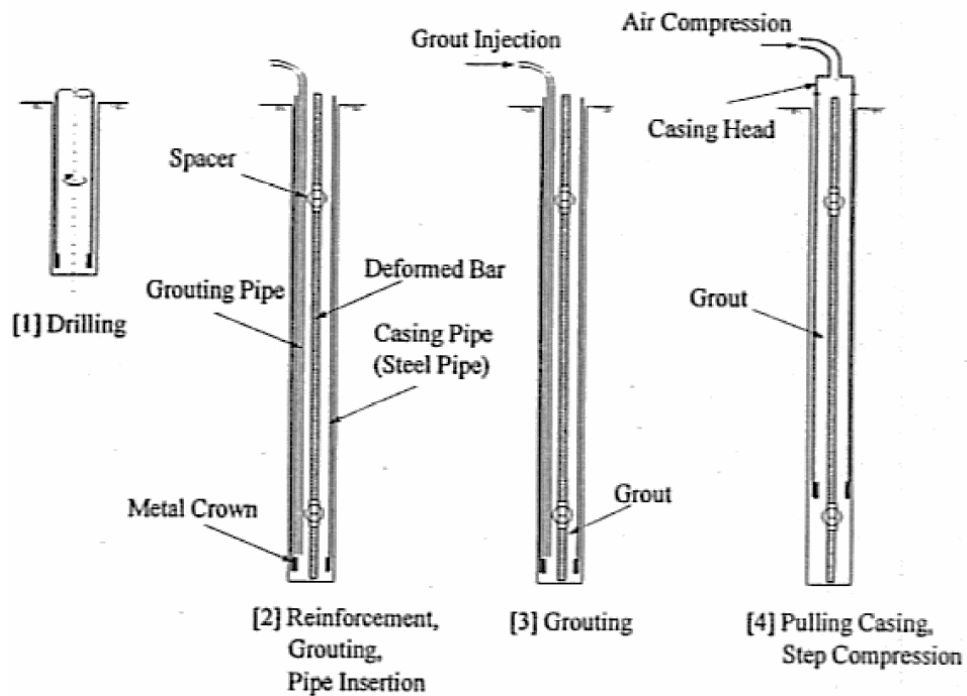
高耐力マイクロパイル工法の施工手順¹⁴⁾
